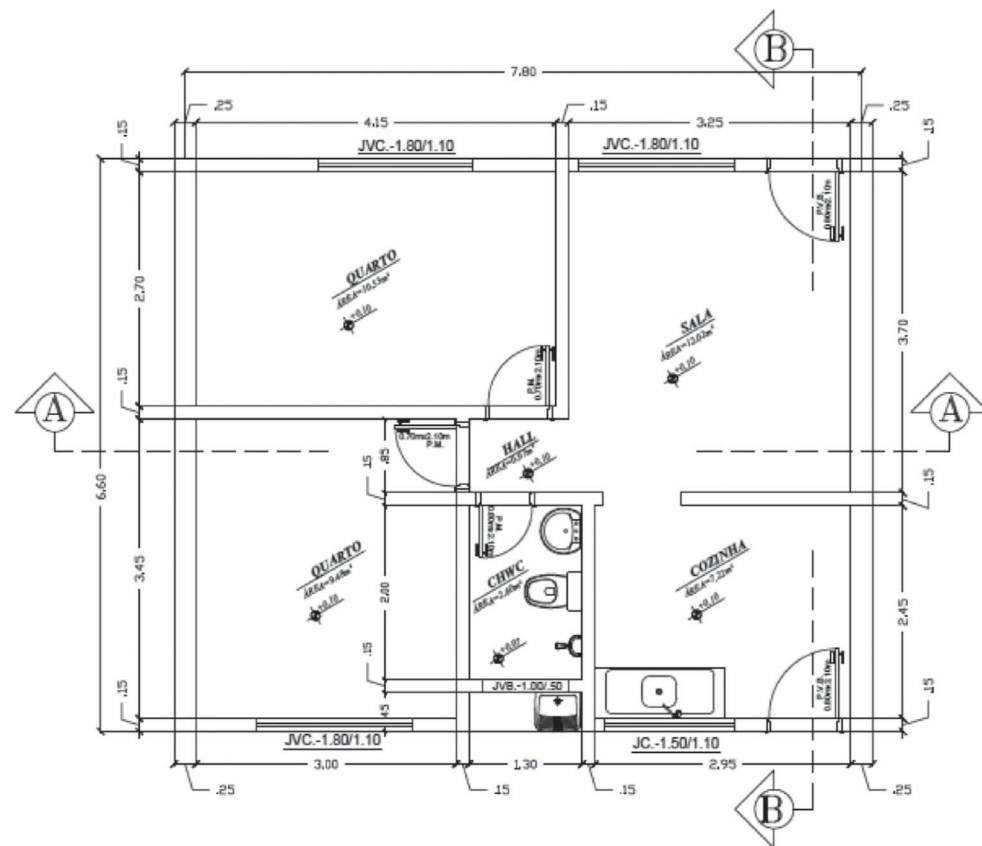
Planta baixa da habitação do estudo de caso.
